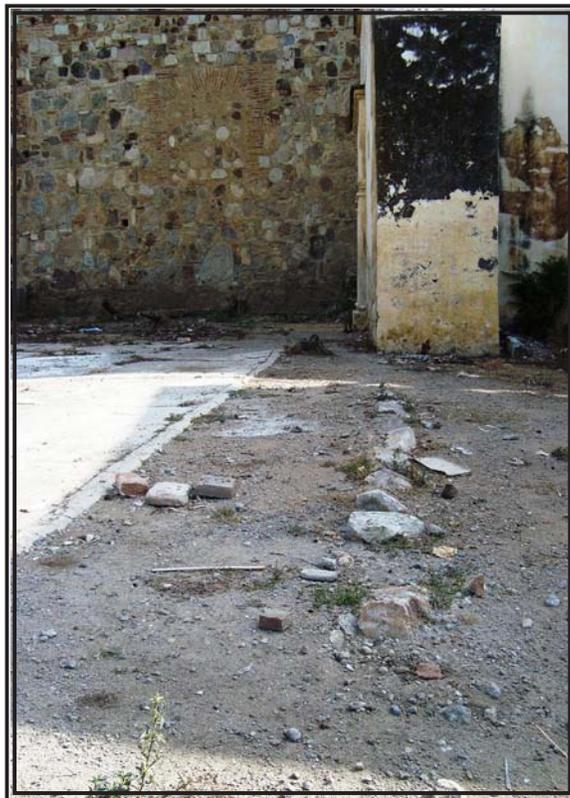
Cimentación que se construyó de cantería verde para levantar un convento al lado sur del templo de San Jerónimo Tlacochoahuaya.
